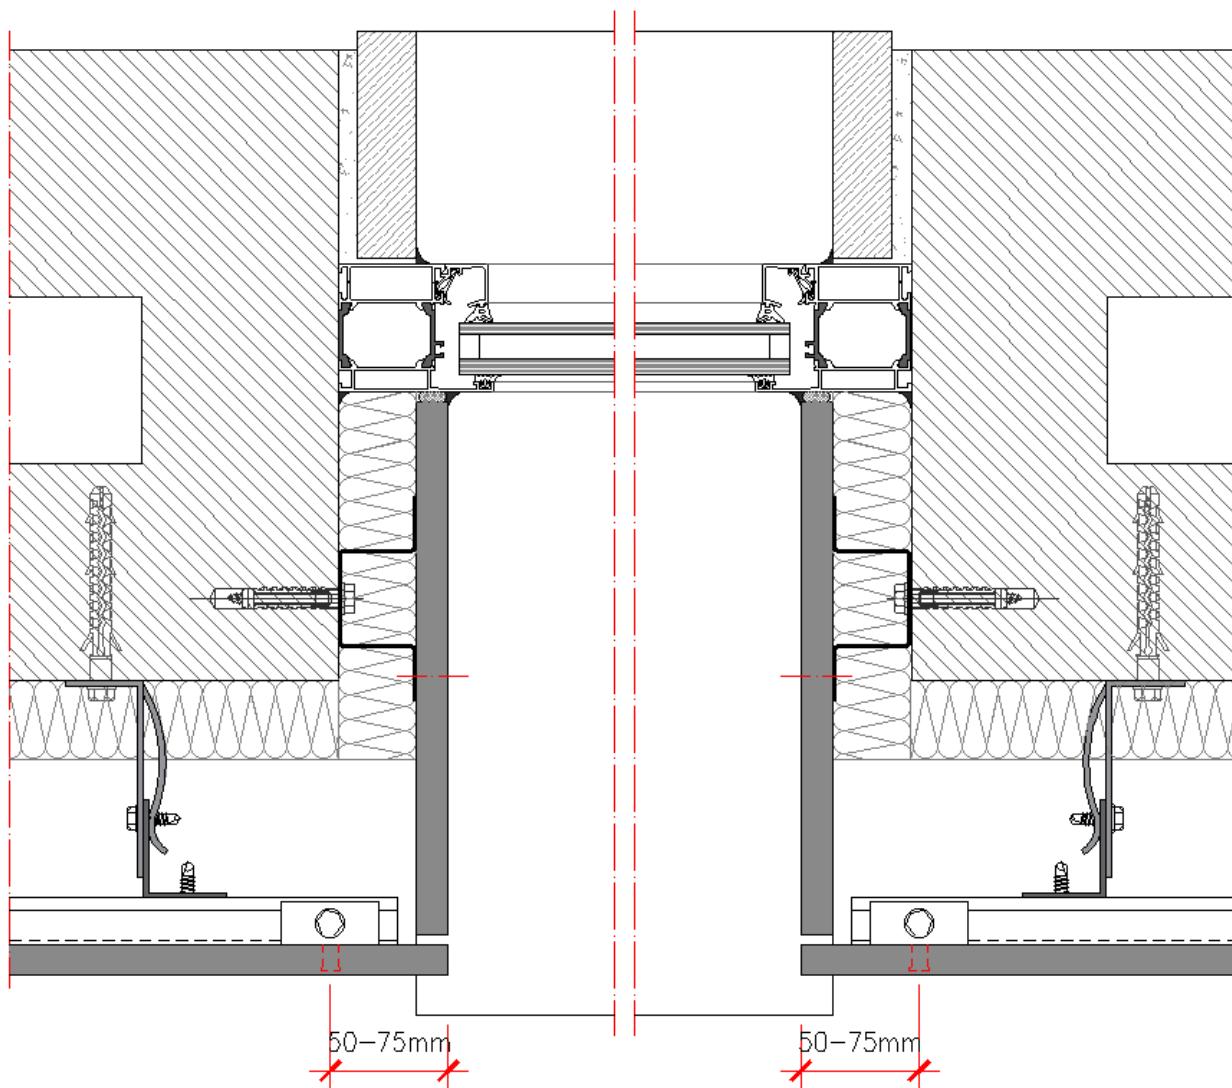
Détail d'une portée de fenêtre, coupe horizontale
